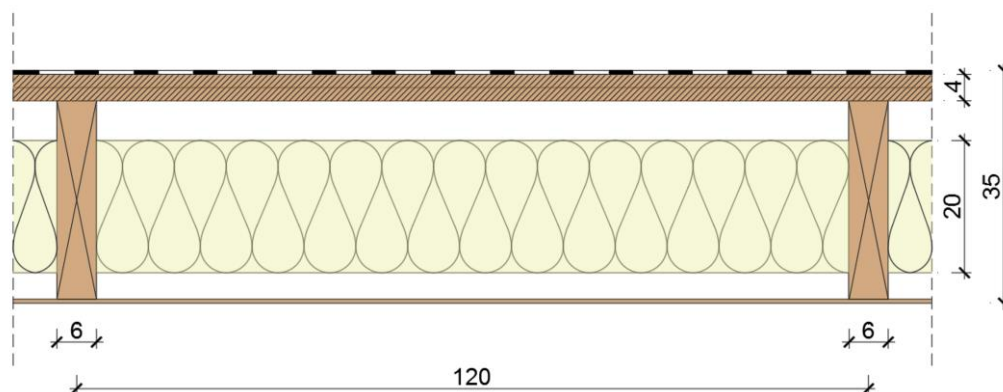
Exemple de façade en structure bois et coupe horizontale
